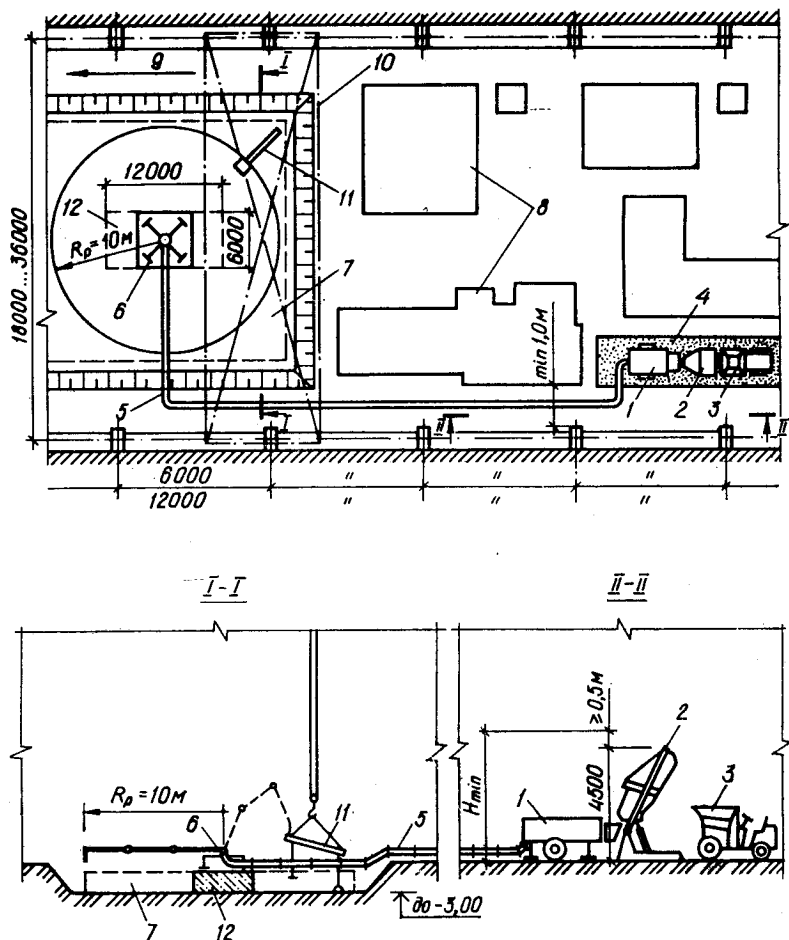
Технологическая схема бетонирования массивных фундаментов под оборудование прицепным бетононасосом с применением распределительной стрелы:
